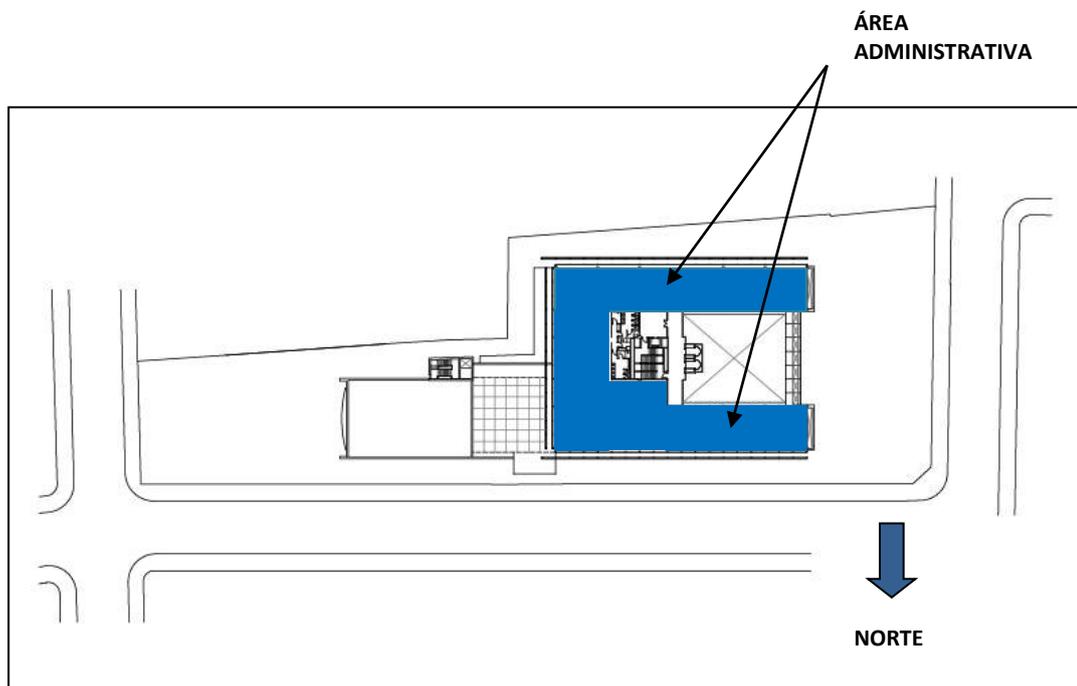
2° e 3° pavimentos – Consulado Britânico, British Council e Cultura Inglesa
